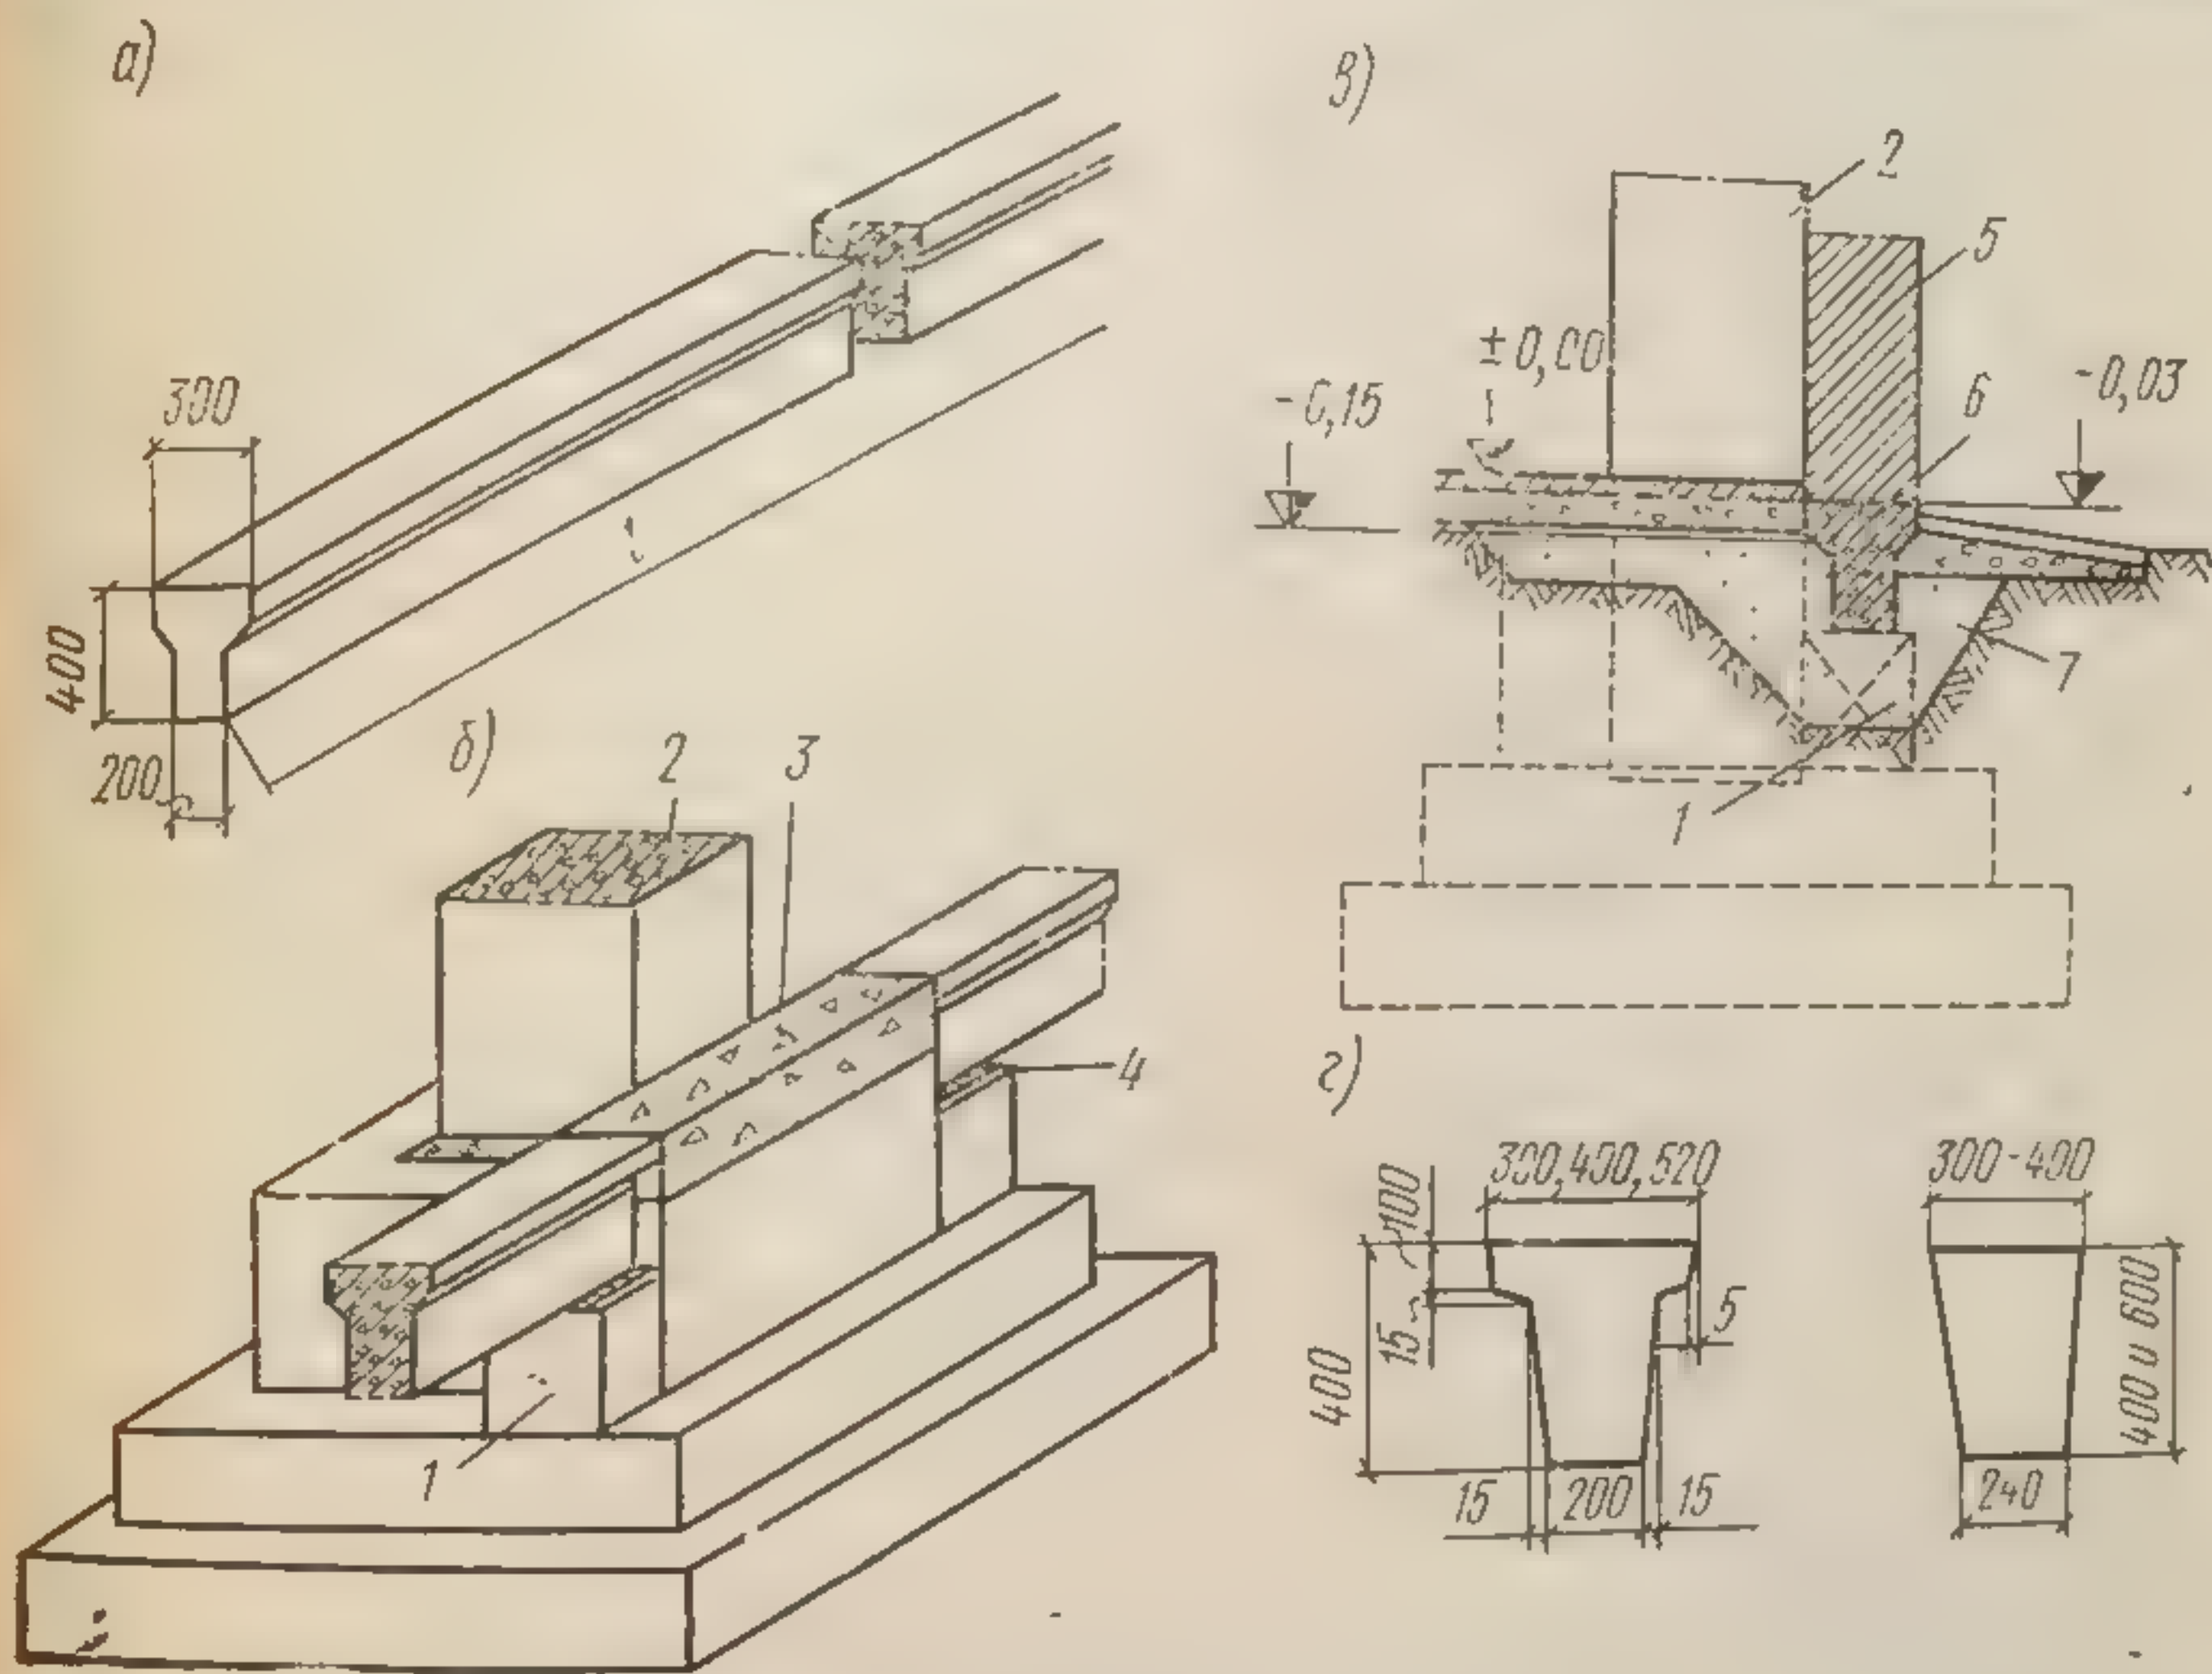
Сборный железобетонный фундамент с отметкой верха 0,15 м и фундаментные балки:
